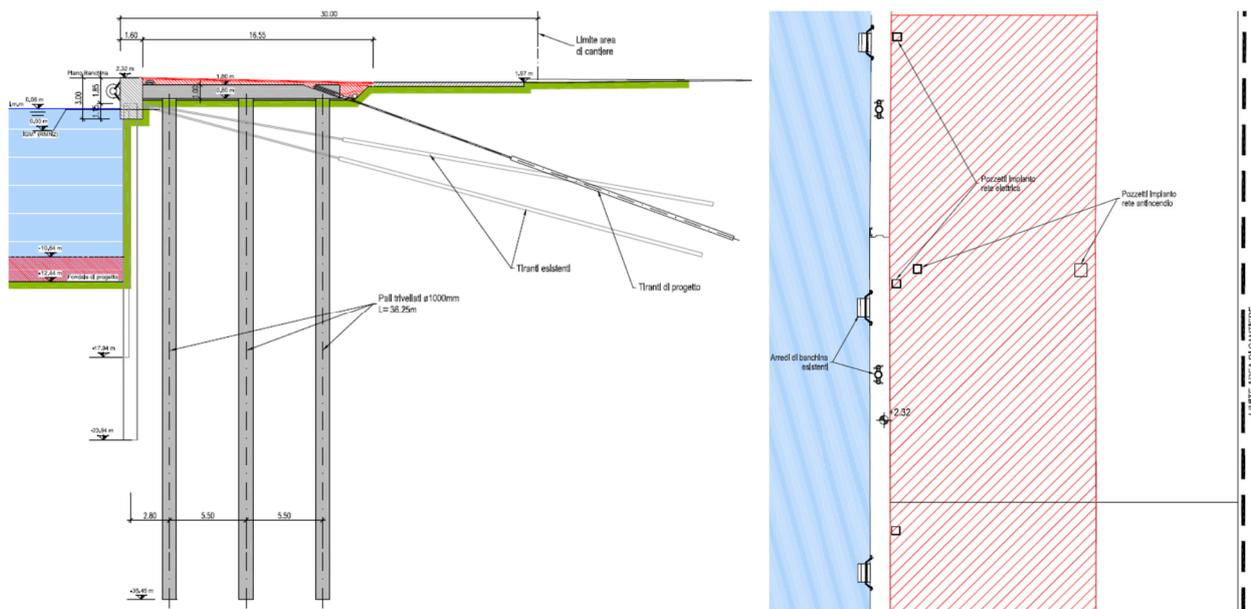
Banchina Trattaroli Nord – Fase 8 – Sezione e planimetria
